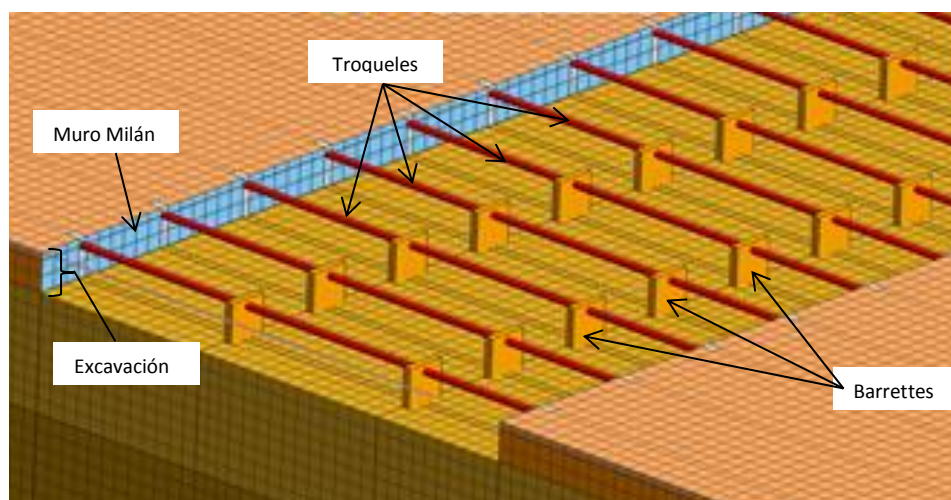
Arreglo tridimensional que muestra la colocación de troqueles de forma lineal perpendicularmente al muro y barretes.
